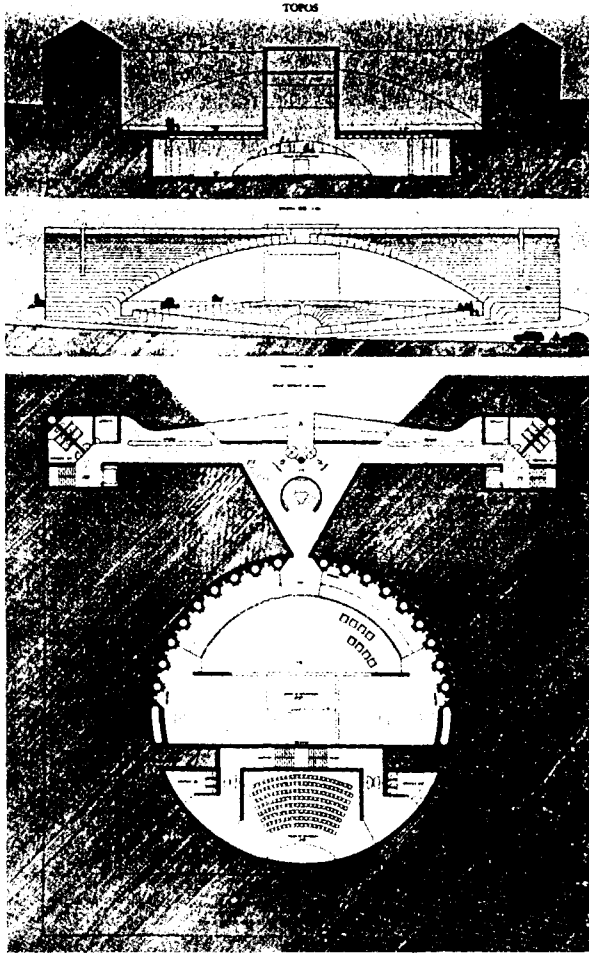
Proyecto de M. Bottà. Planta. Alzado exterior y sección.
